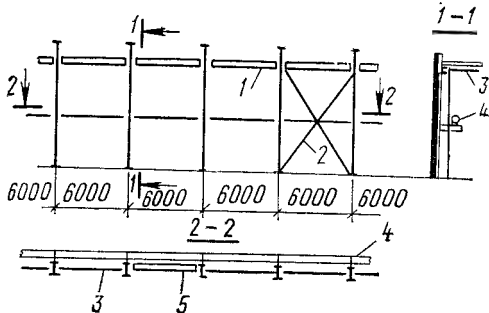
Пример решения торцевого фахверка, стойки которого служат опорами покрытия или перекрытия
